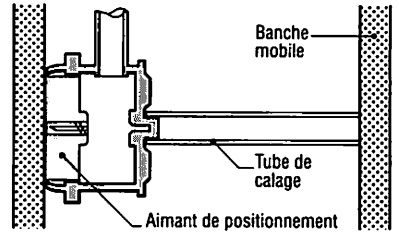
Fixation d'une boîte d'appareillage dans un coffrage vertical.
